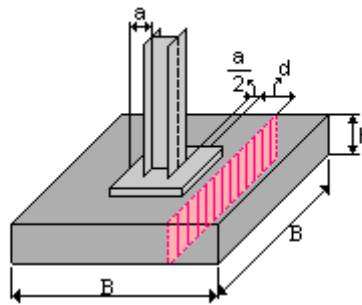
Cortante Unidireccional en Zapata que Soporta Columna Metálica.
